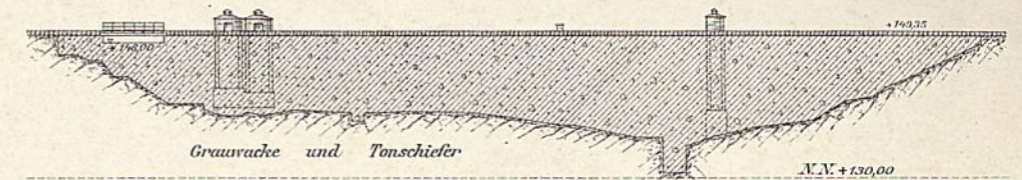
Längenschnitt durch den Betonkern. 1:1000.
